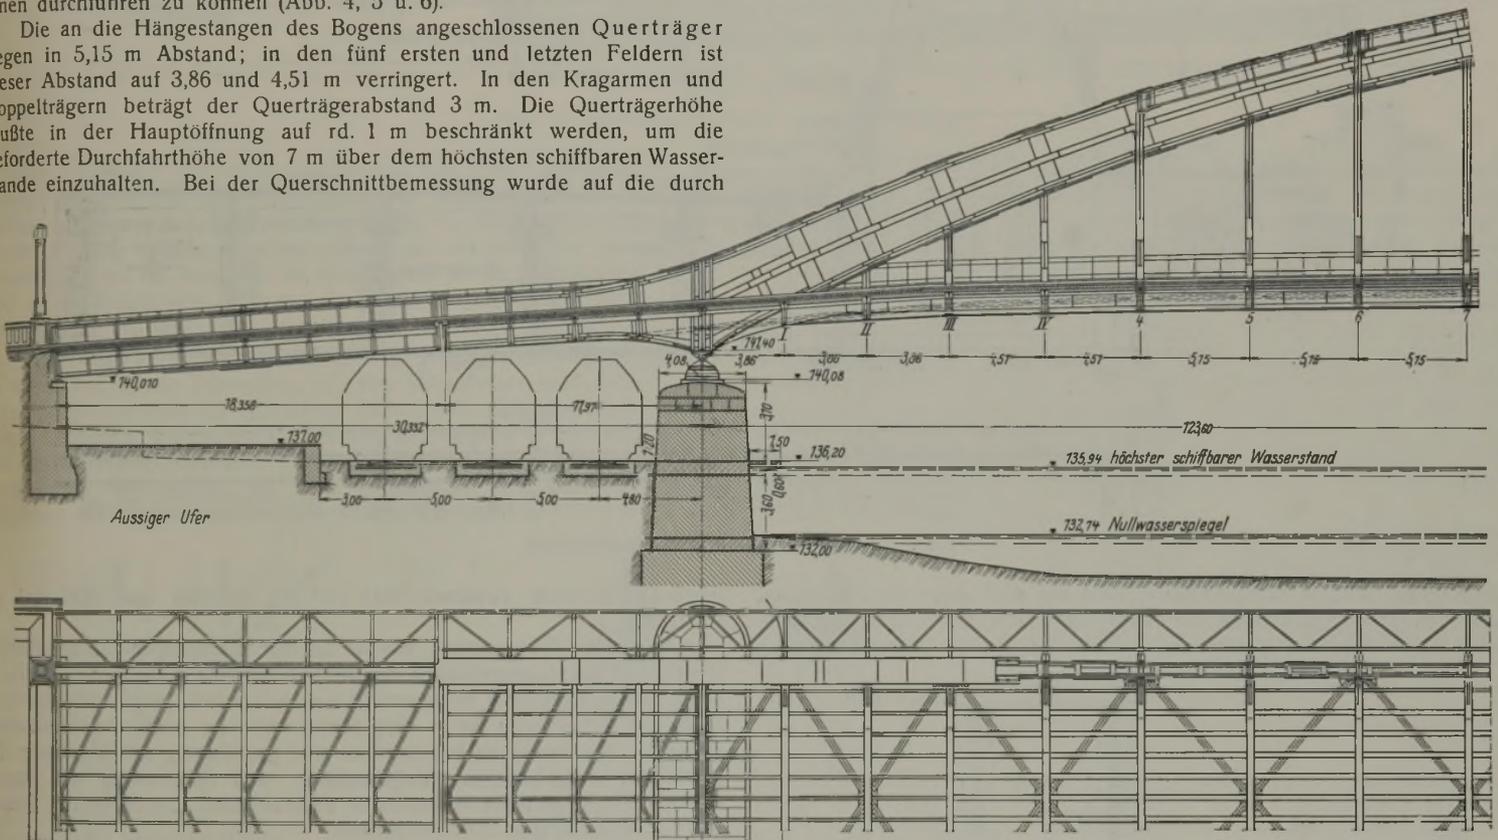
Längenschnitt und Grundriß des linken Brückendes. 1:350.
